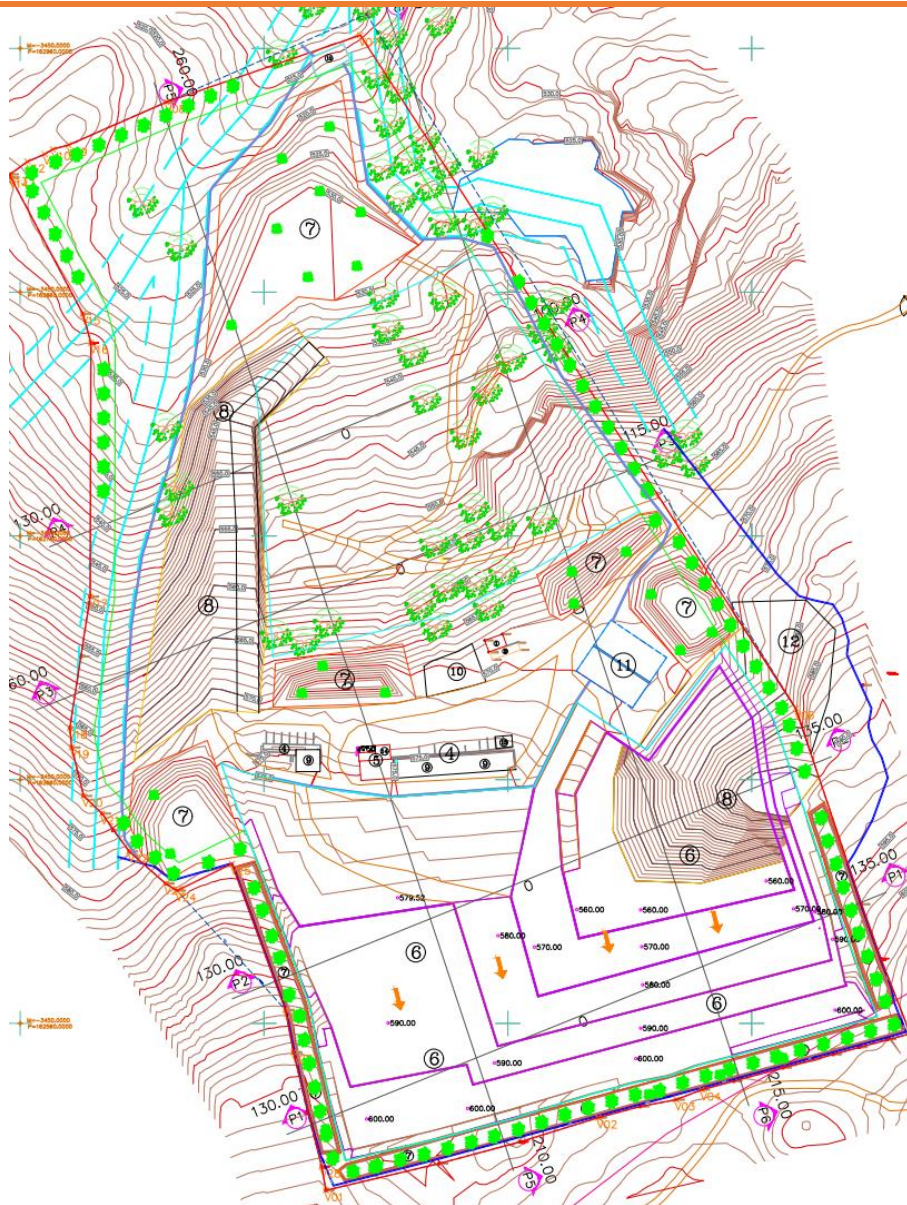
Planta de escavação – Exploração a 10 anos.
